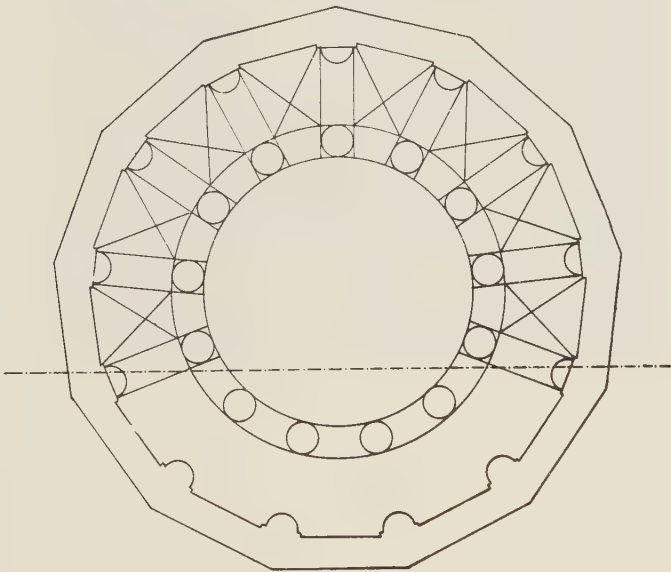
Architektur des Pala-Bildes. Grundriß-Rekonstruktion II.
